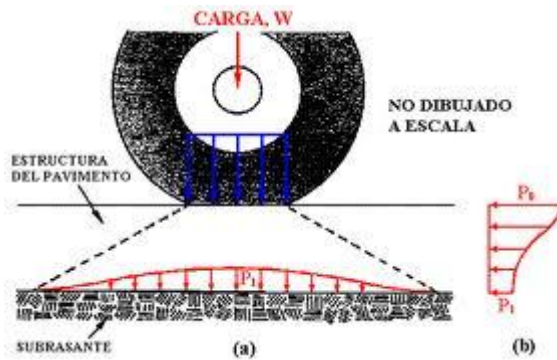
b.10 Distribución de presiones en la estructura de un pavimento.
